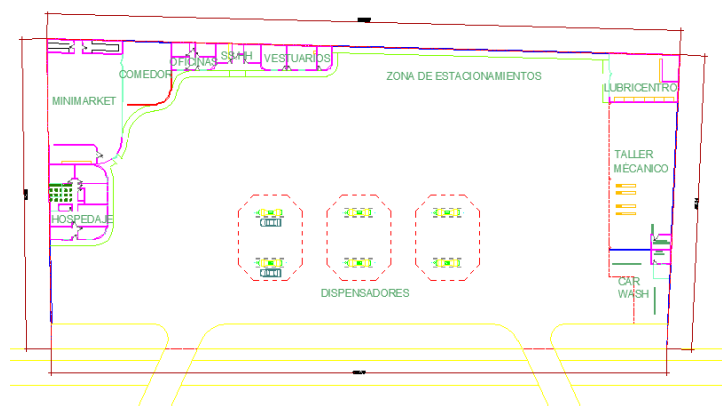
Estación tipo turística. (Anexado en el plano A-01)
